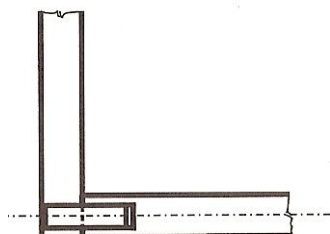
Spoj pero-drážka – obtížně proveditelný spoj
